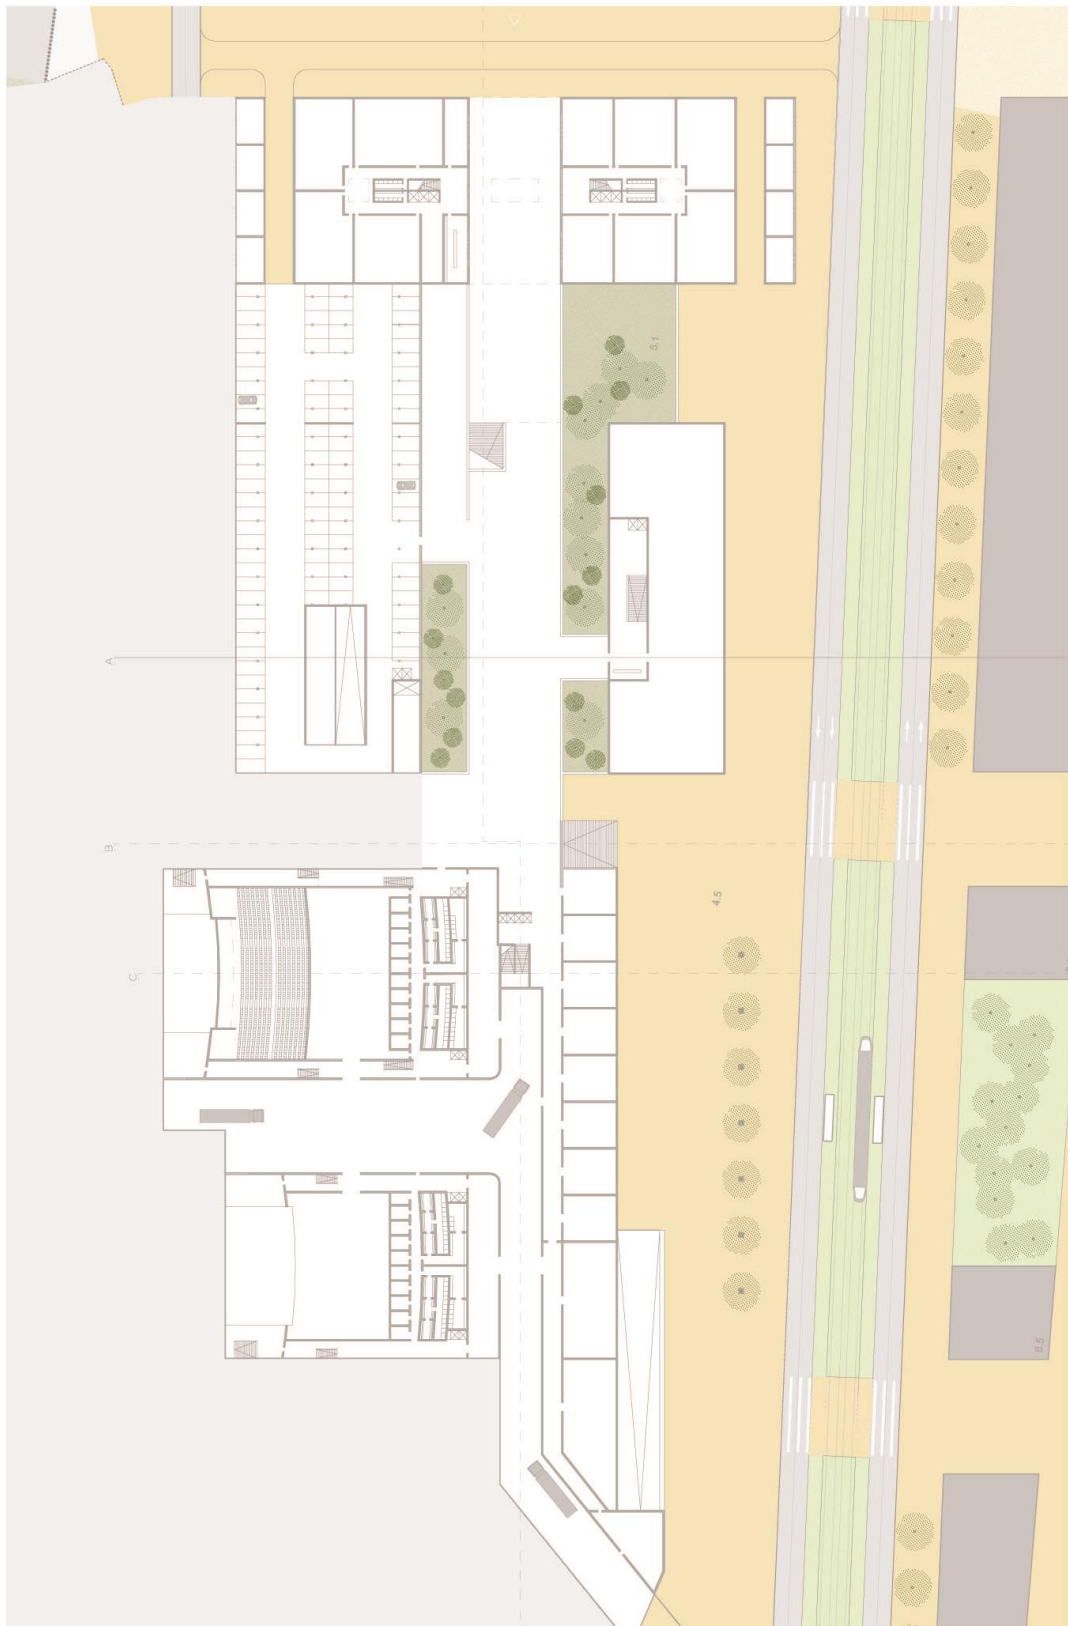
Planta piso 0, cota 4.5. Fonte: Aurora
